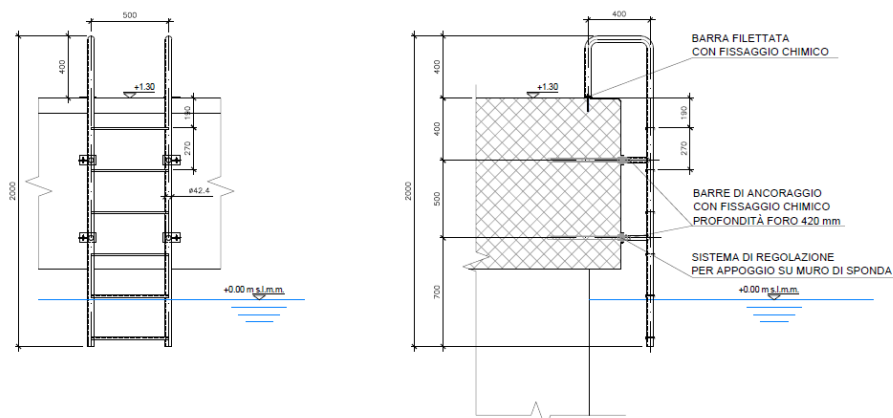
Scalette in progetto - Estratto dalla tavola B14 - Arredi di banchina
